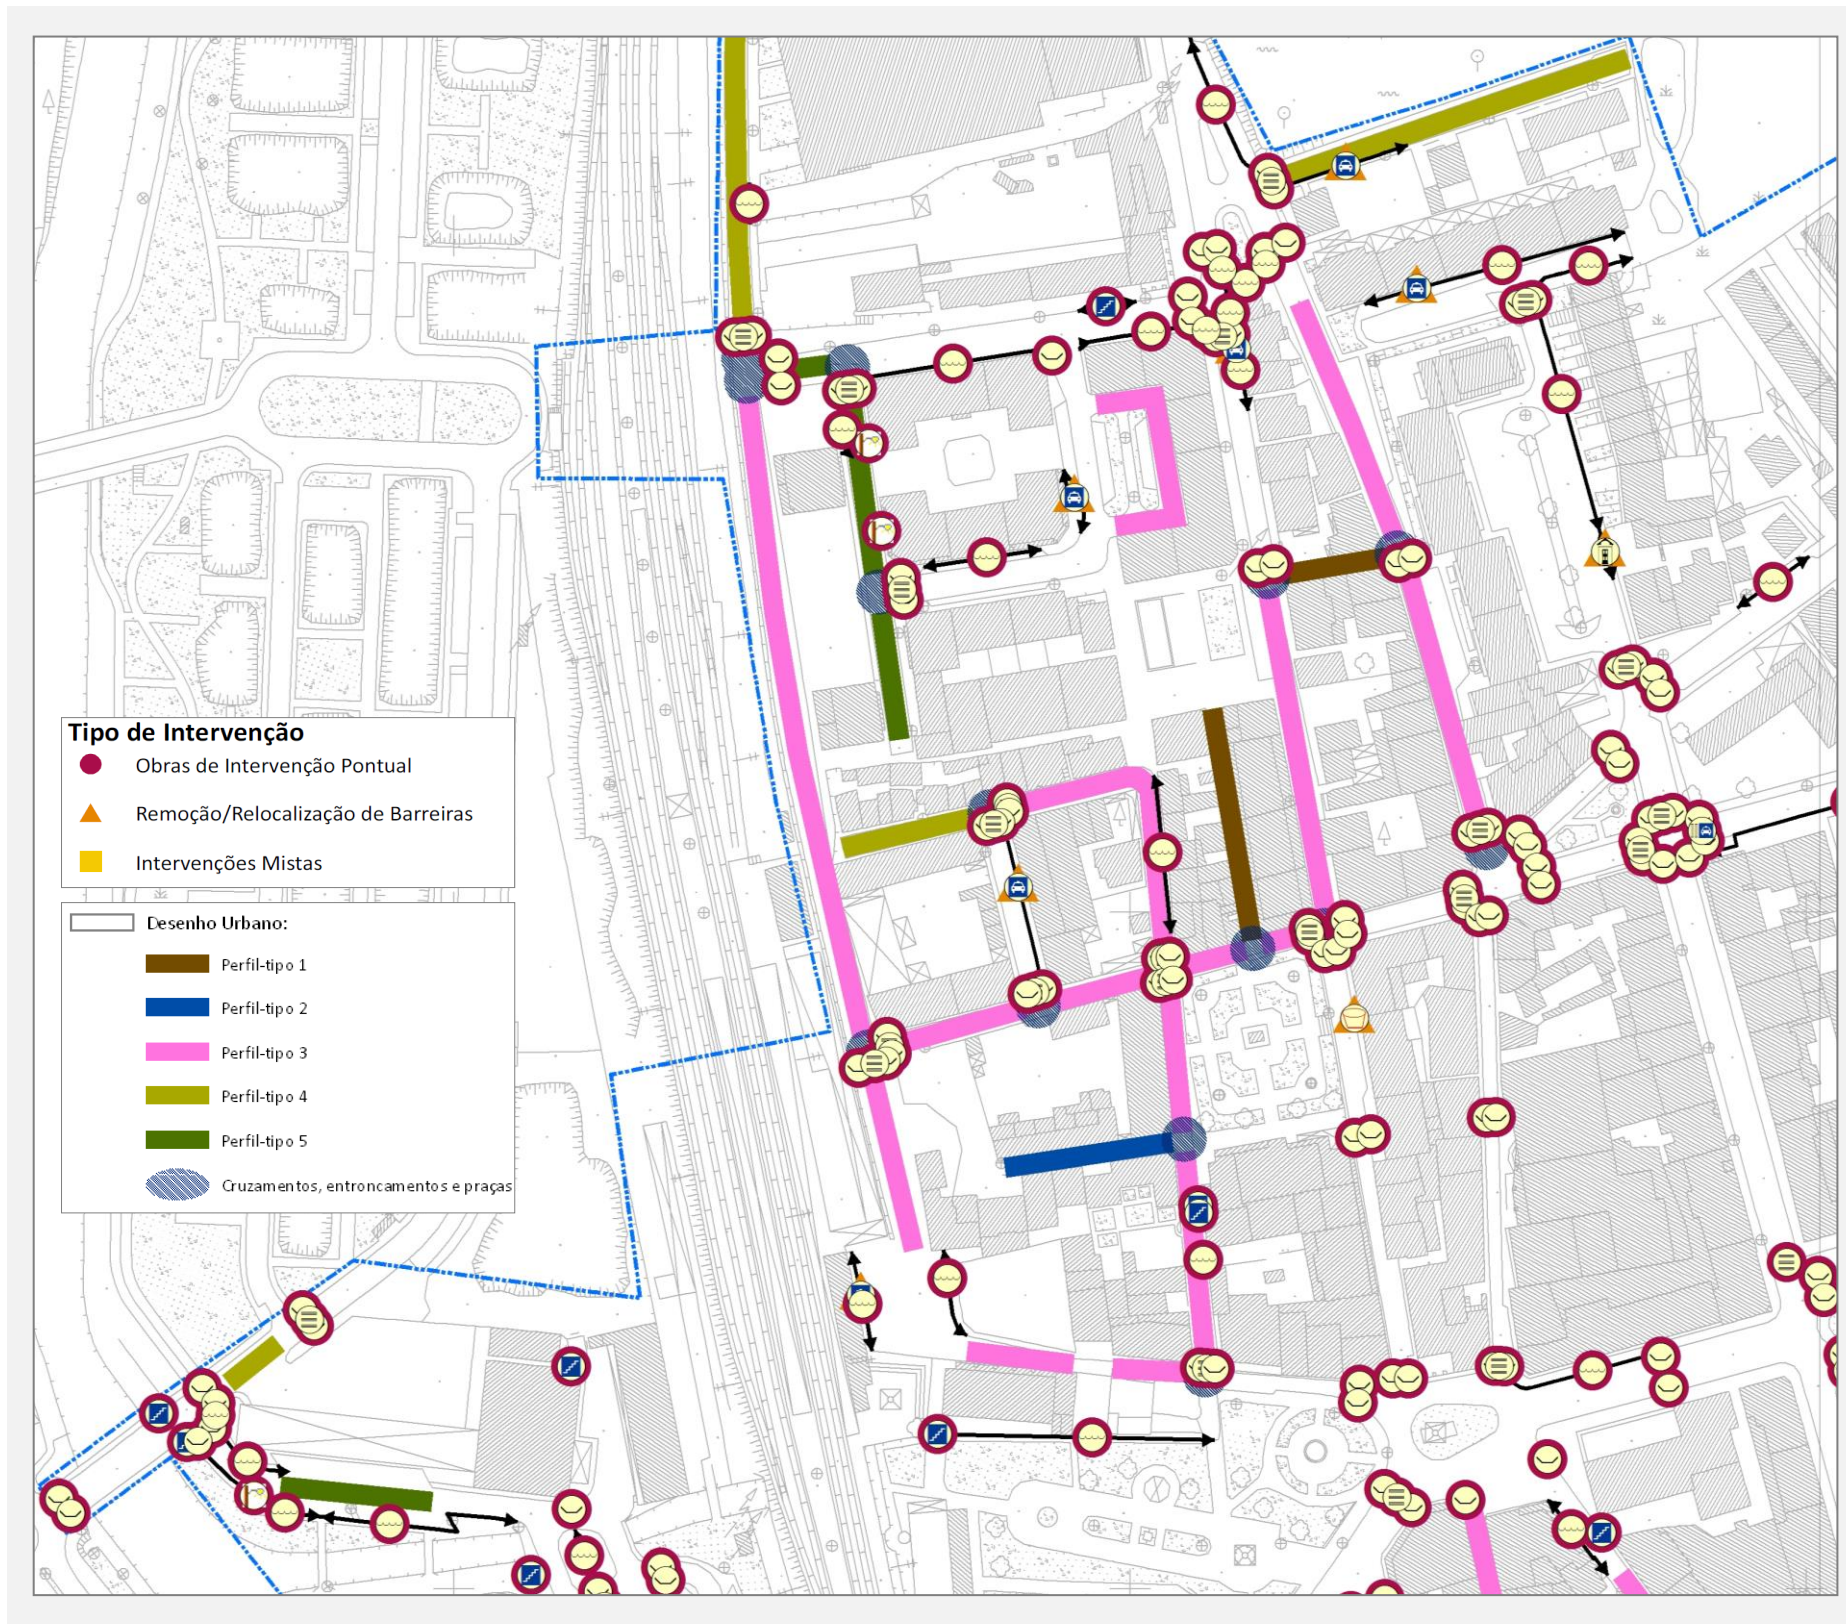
Extrato de Planta de Tipologias de Intervenção – Planta Síntese
